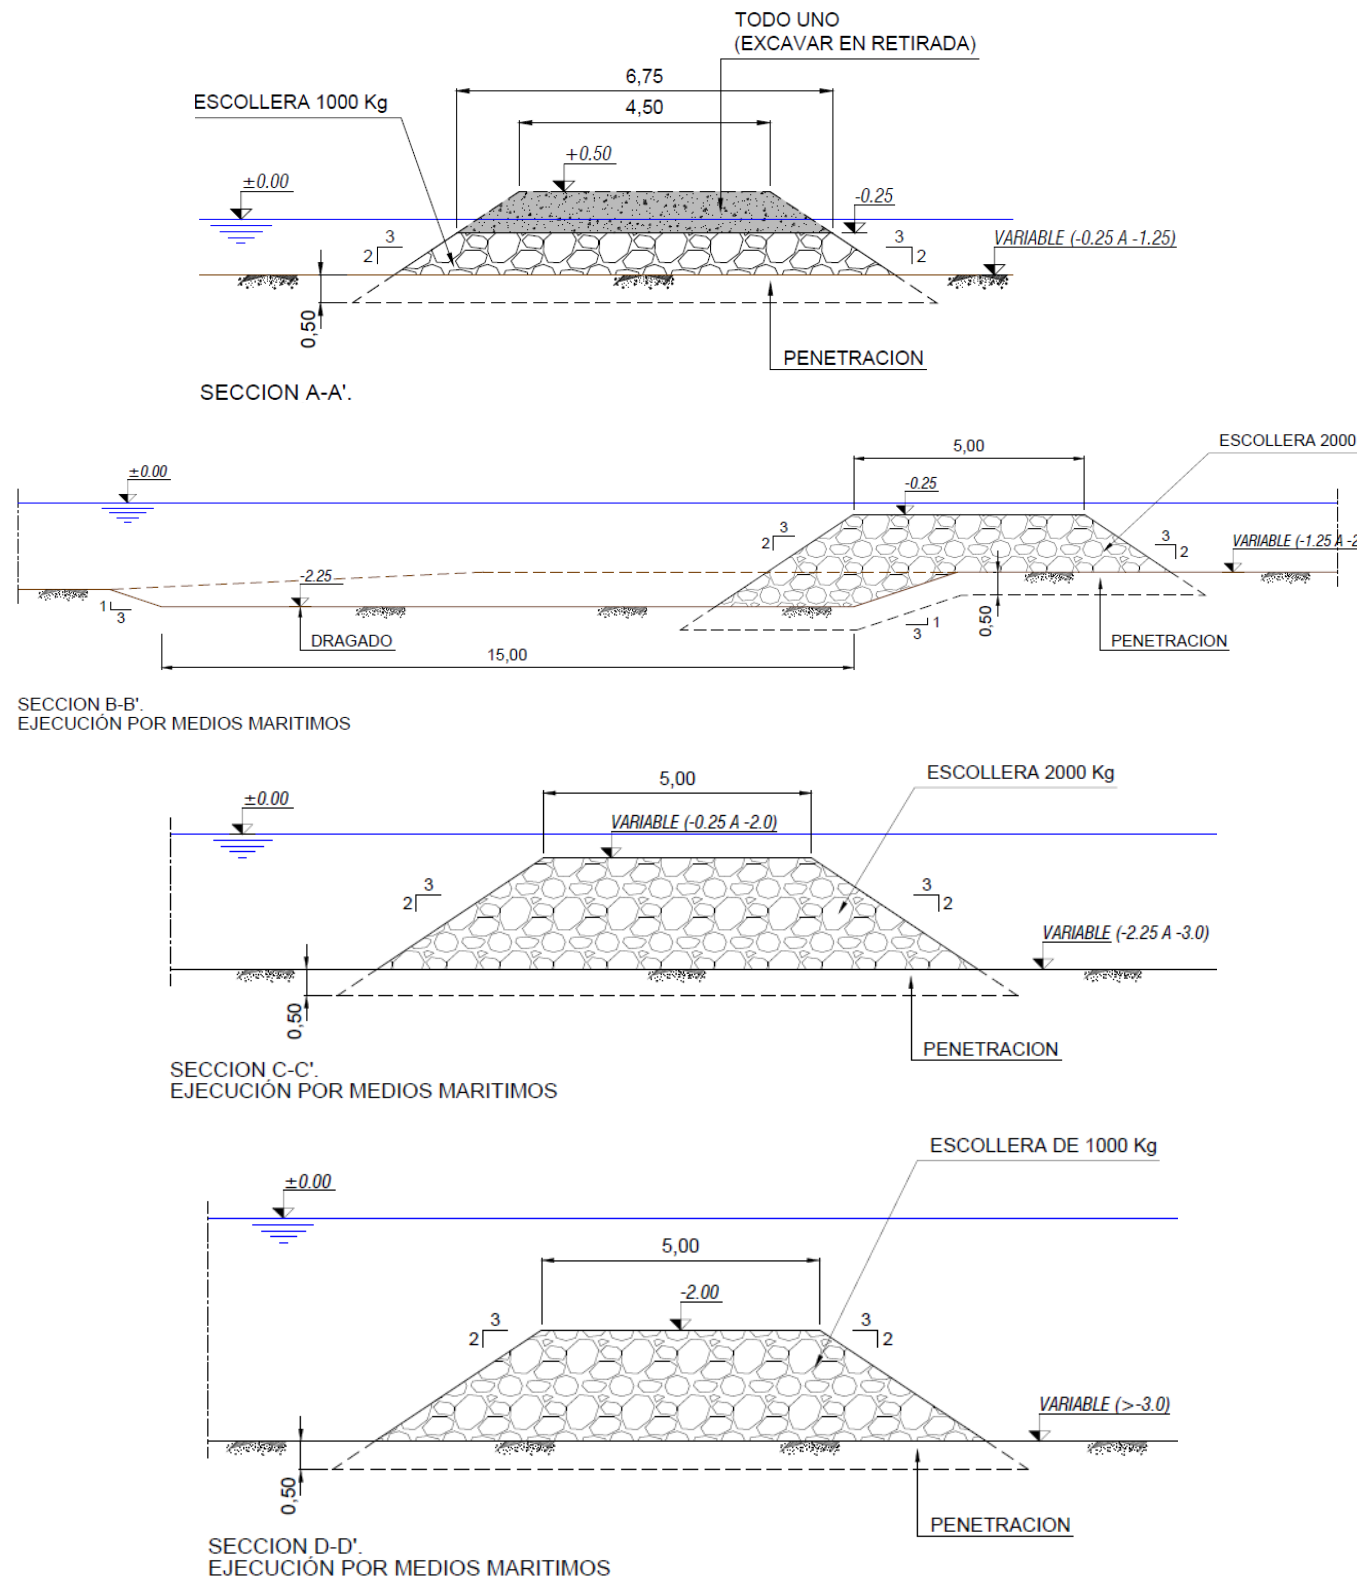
Secciones tipo del espigón (Fuente: elaboración propia)
